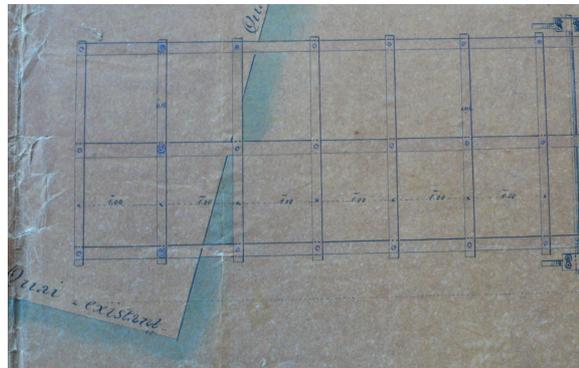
1882, Plan du débarcadère sur la base du quai existant
